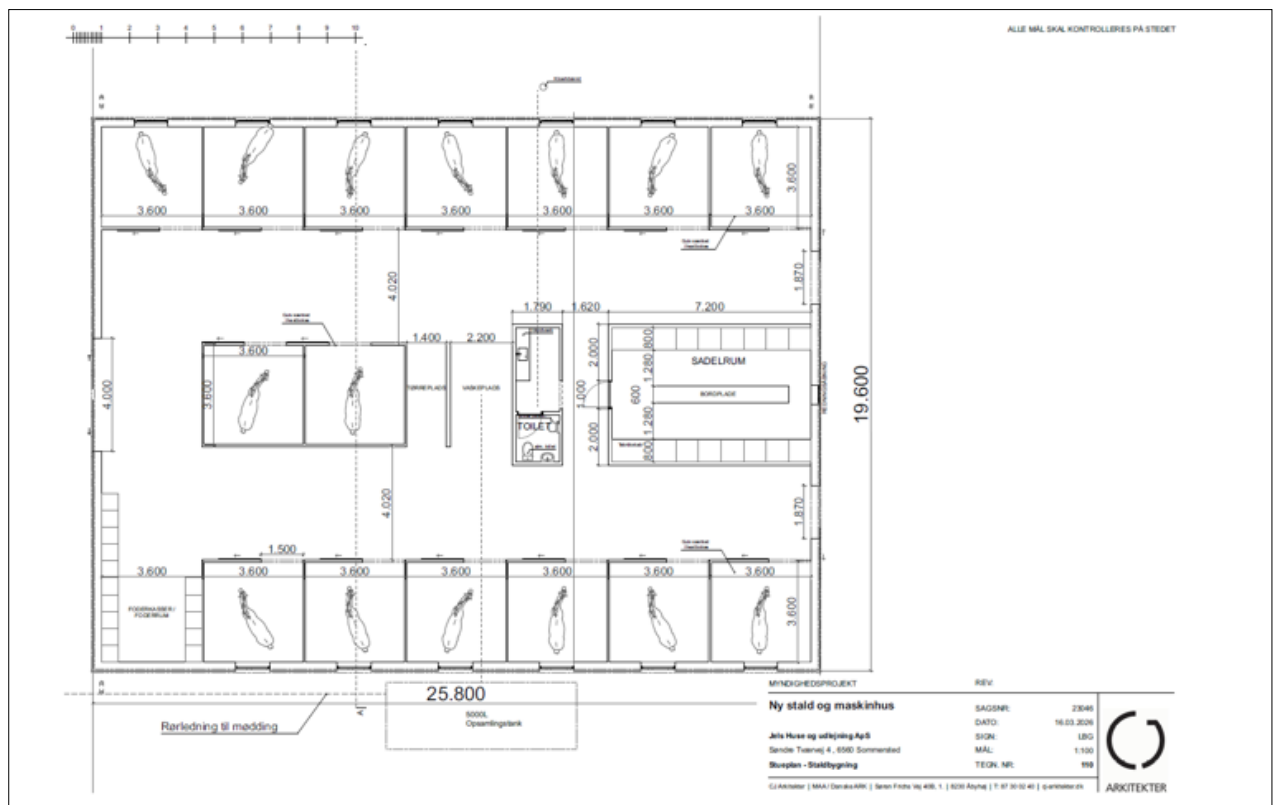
Oversigtstegning fra ansøgningen med placering af de ansøgte anlæg
